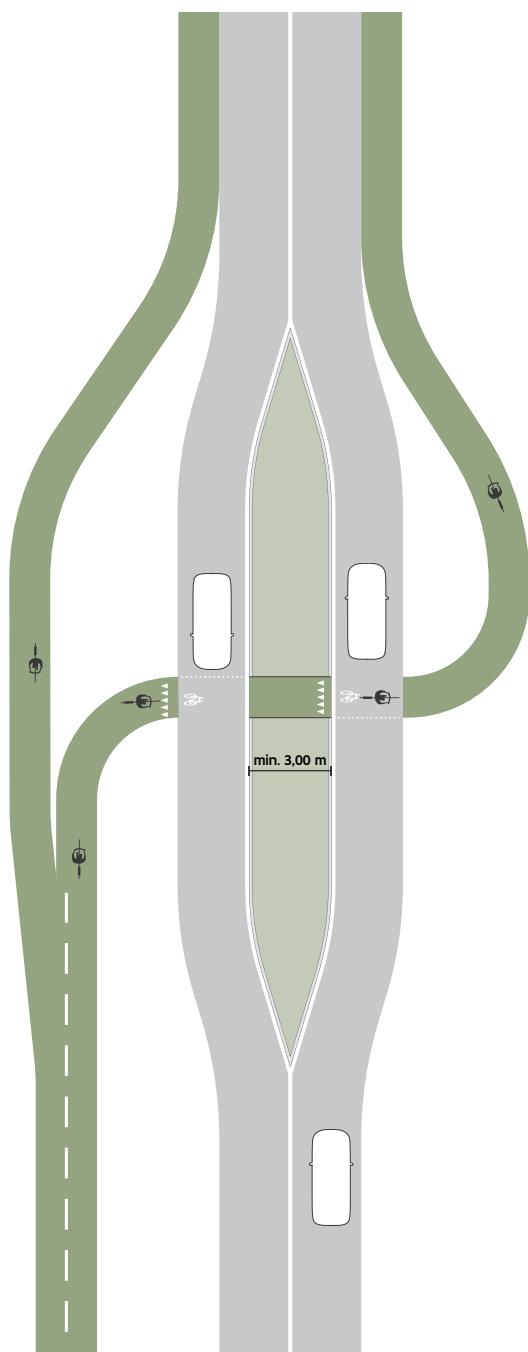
Overgang tussen eenrichtingsfietspad en tweerichtingsfietspad
